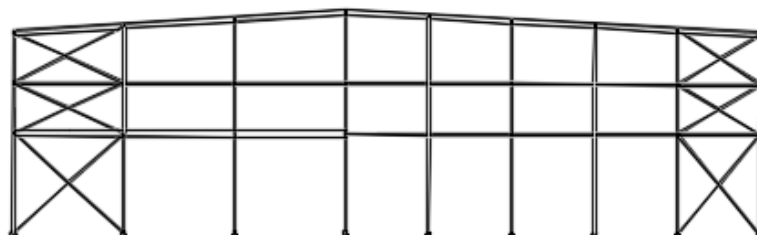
Pórtico de fachada A. (Fuente: Cype 3D)
